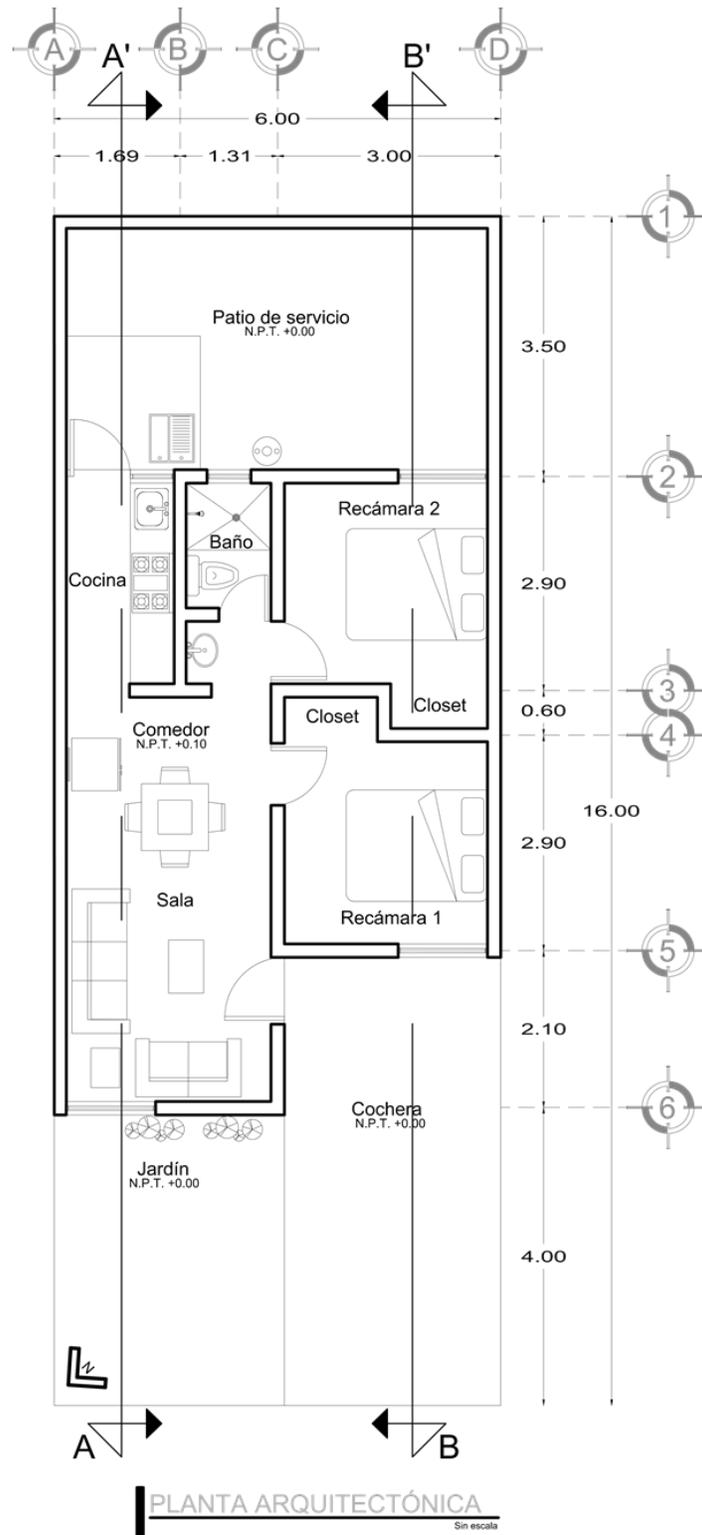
Planta arquitectónica vivienda* Fuente: Elaboración propia.
